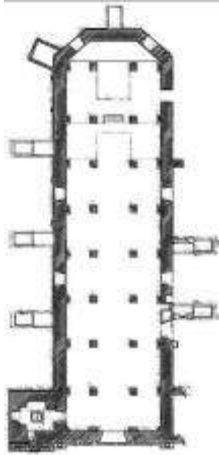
Planta Arquitectónica del Templo de Tiripetío Michoacán, México.
